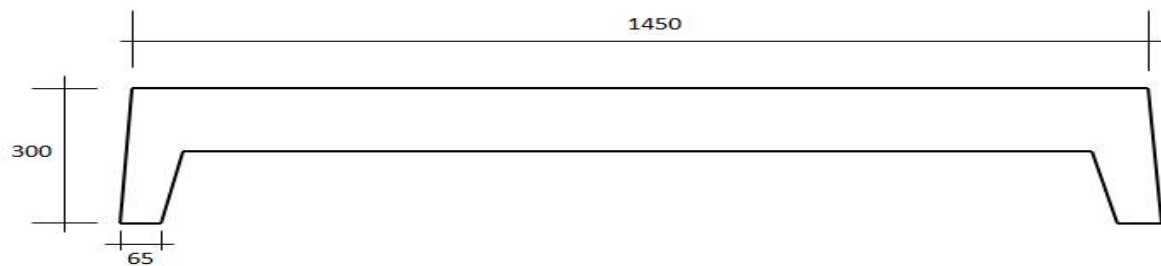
Схема перерізу досліджуваної ребристої залізобетонної плити.
